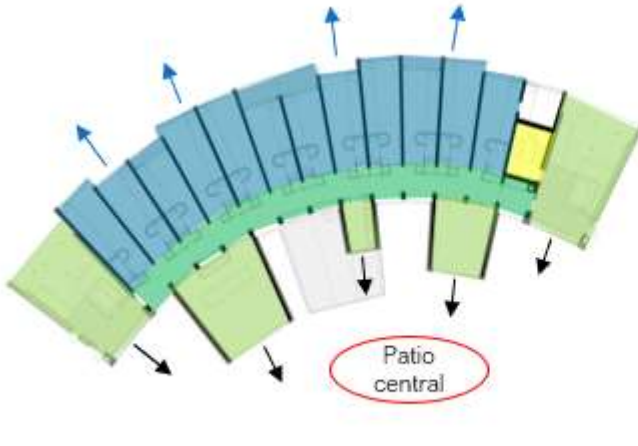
Planta arquitectónica. de: Lundgaard & Tranberg Architects. 2005, <https://www.archdaily.mx/mx/02-334957/tietgen-dormitory-lundgaard-and-tranberg-architects>
